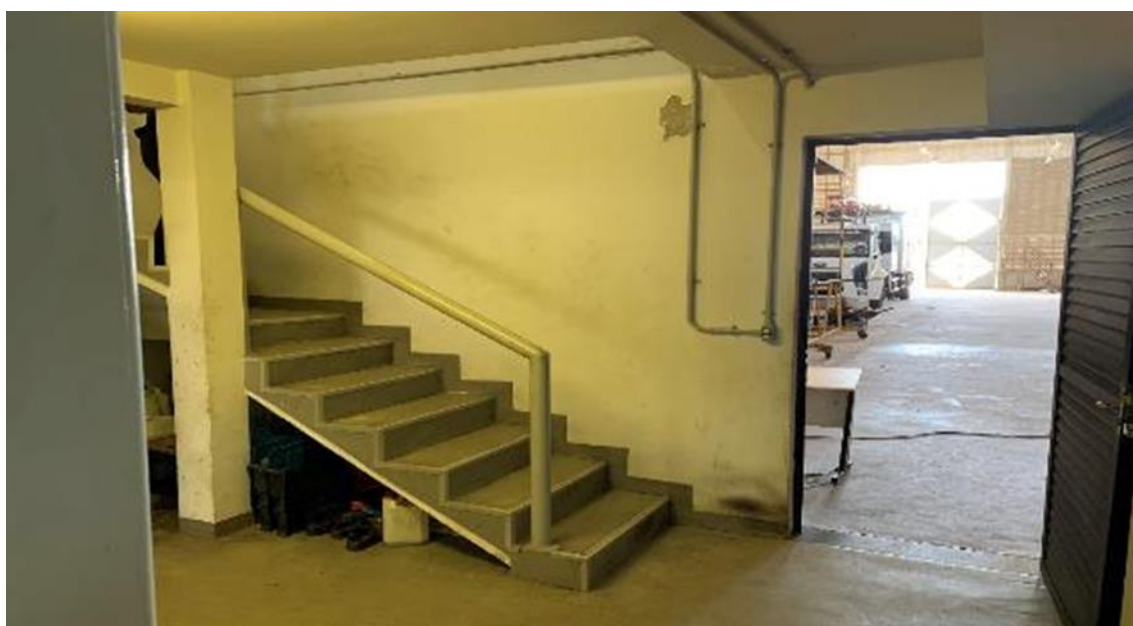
Hall de acesso às instalações de apoio. Pintura desgastada
